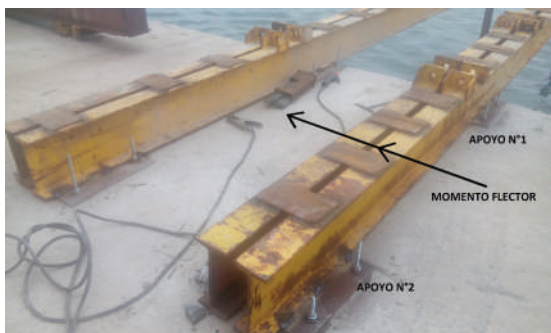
Ejemplo de anclaje de superestructura a un piso de hormigón
